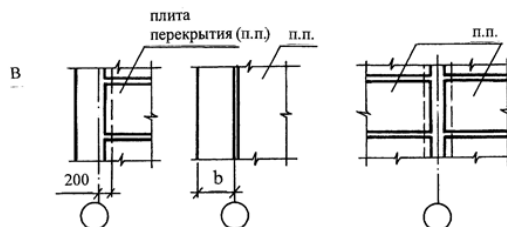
Привязка конструкций здания со стенами из кирпича:
